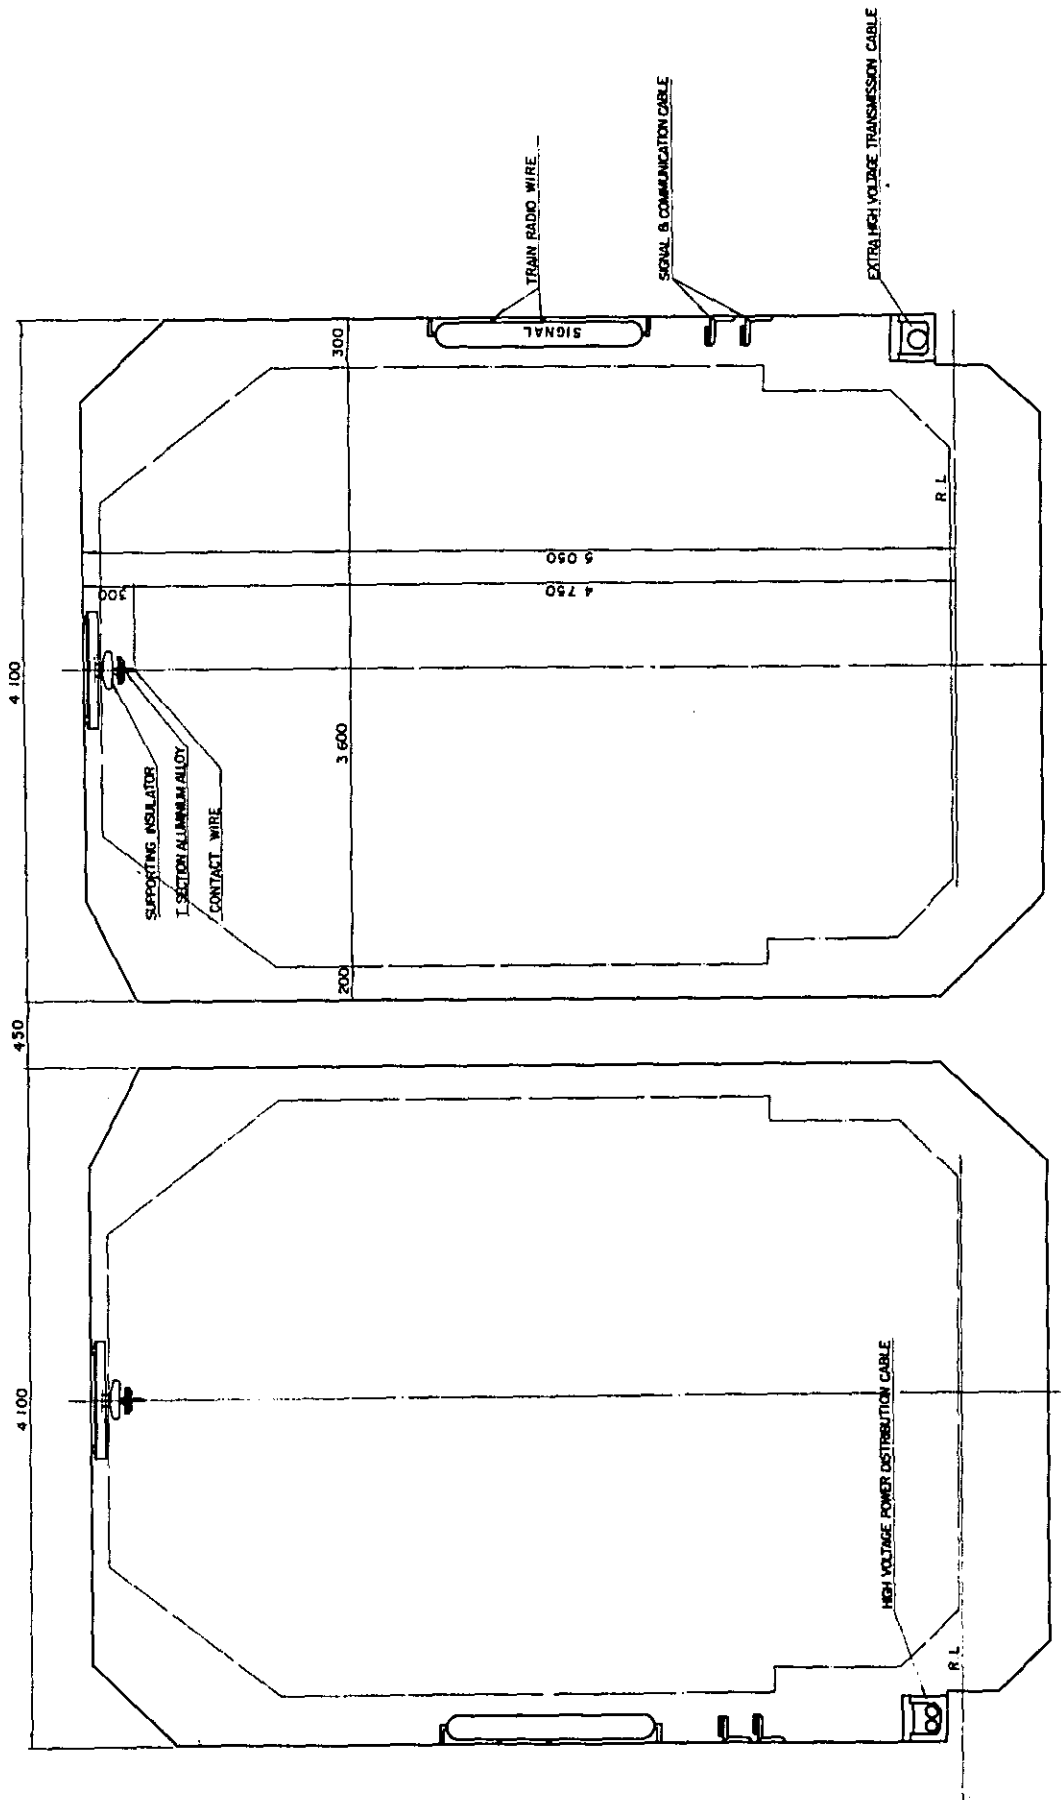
電気設備標準構造図 (山岳 TUNNEL 区間)
